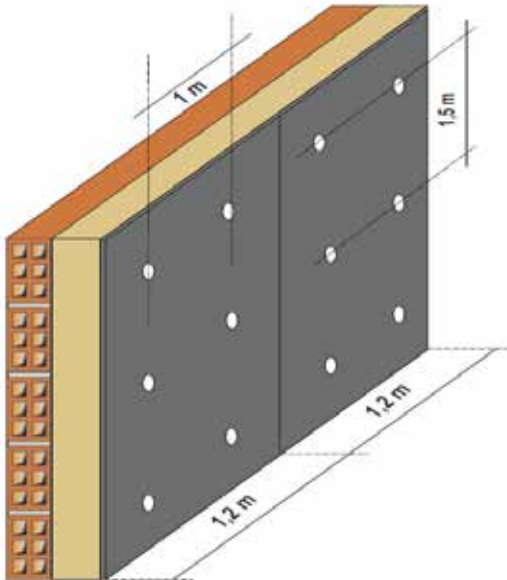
Rollo de aislamiento de lana mineral. Patrón de anclajes para un aislamiento en rollo.
